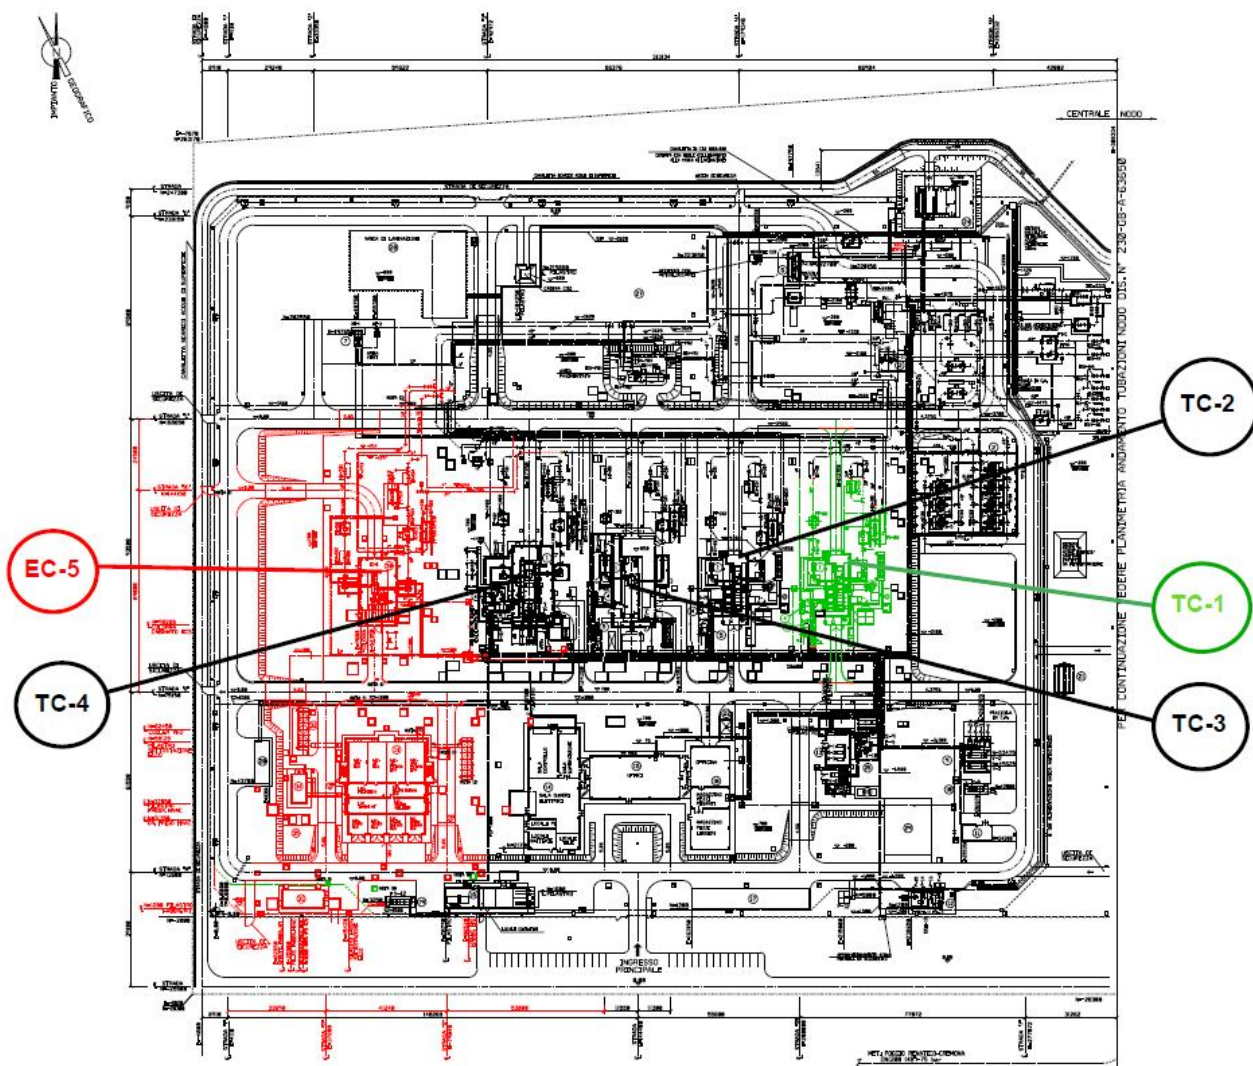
Planimetria generale andamento tubazioni (in rosso le nuove realizzazioni in progetto, in verde le dismissioni previste)
